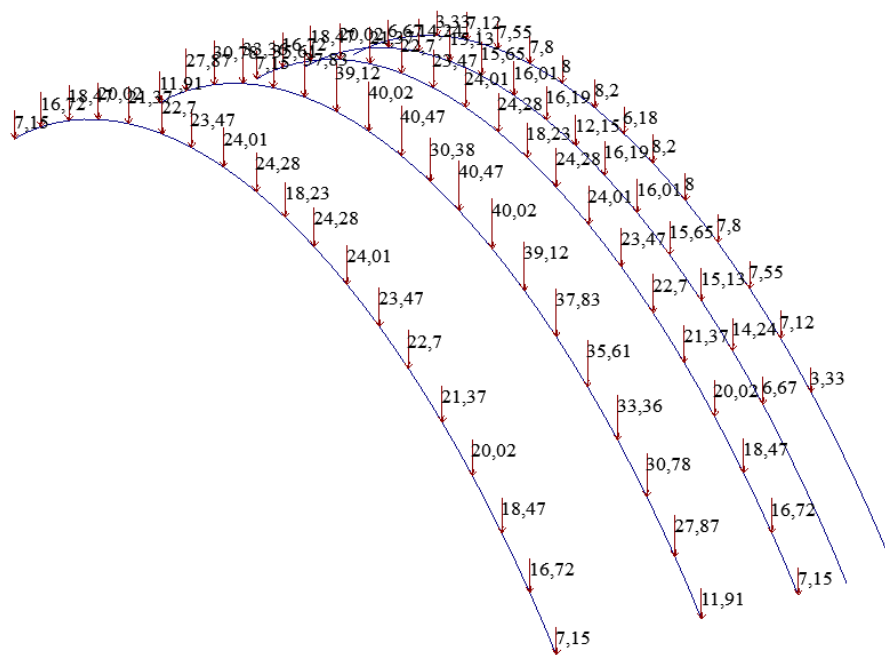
Схема приложения снеговых нагрузок на арочное покрытие блоков Г и Д (вариант 1)
